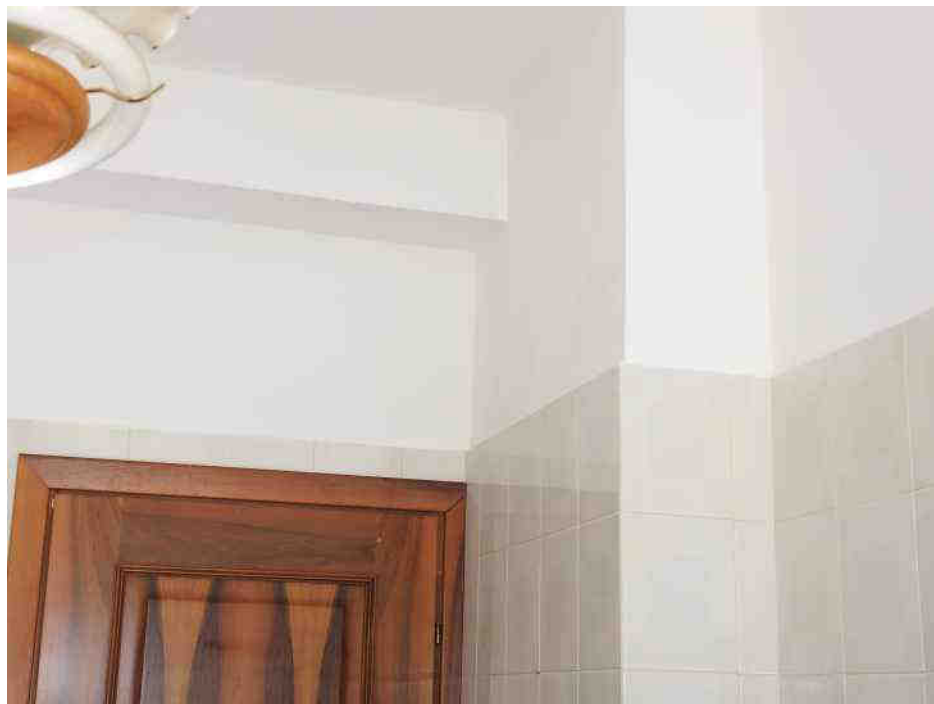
PV8: Vista pareti interne della cucina (stanza 2)
